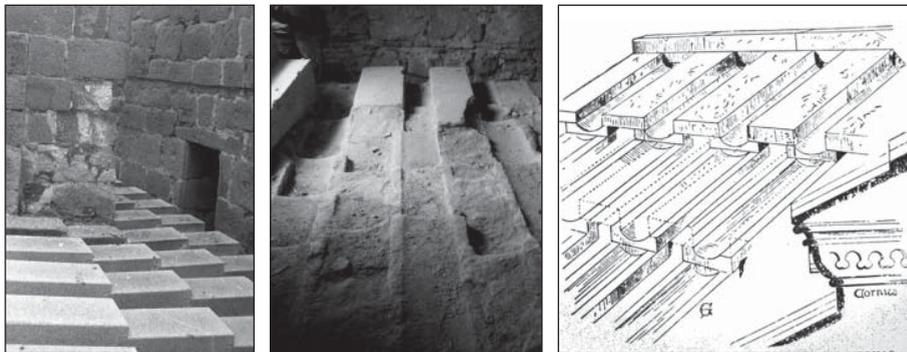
Fotografías de la cubierta de piedra del cimorro colocada en la restauración, de los restos de cubierta pétreo primitiva, dibujo del antiguo sistema de cubrición de la catedral de Ávila con losas de piedra, realizado por O. Jewitt en 1865.
